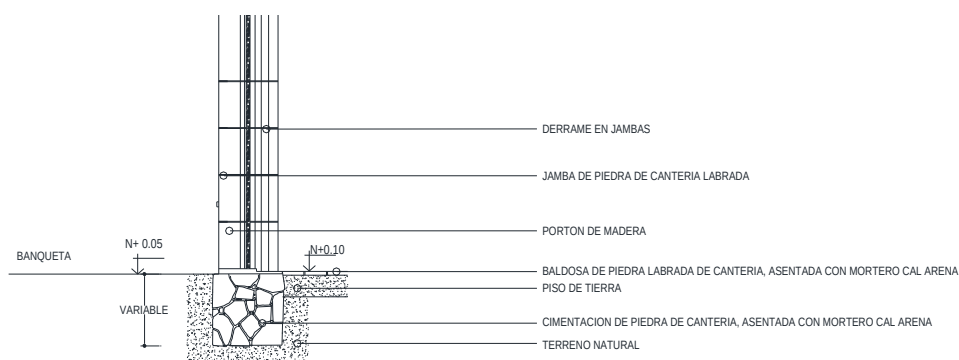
Detalle de la cimentación en muros. (Elaborado por José A. Morales A.)
